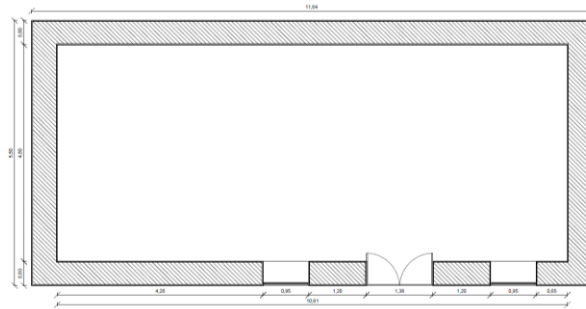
Planta piso -1 rés-do-chão, Casa das Queimadas.
